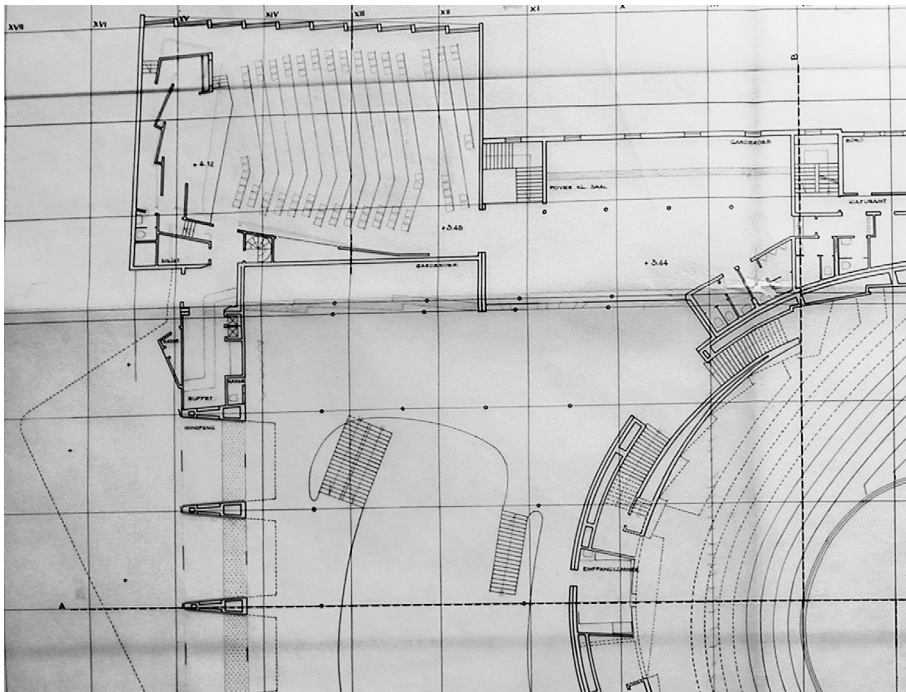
Grundriss 1. Obergeschoss, Silchersaal und Kleines Foyer, Büro Gutbrod, 1956.
